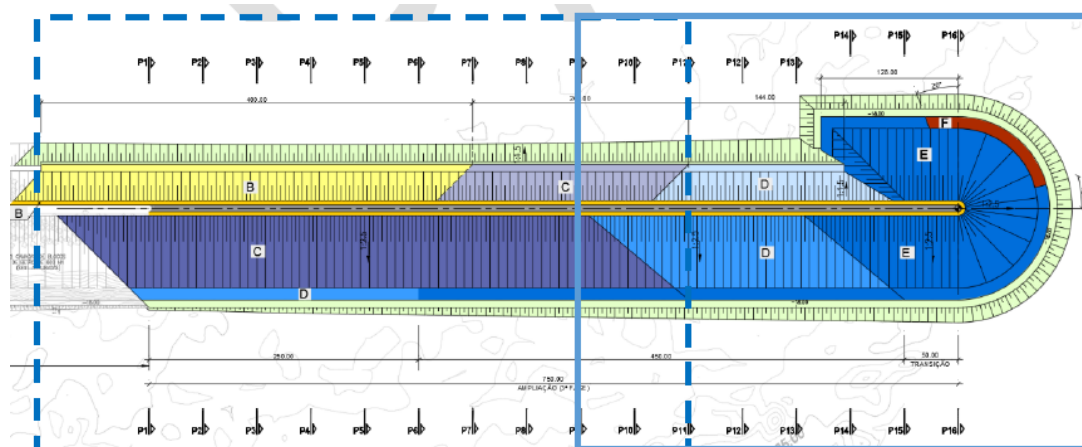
Planta do prolongamento de 750 m a construir. Trechos ensaiados em 2017
